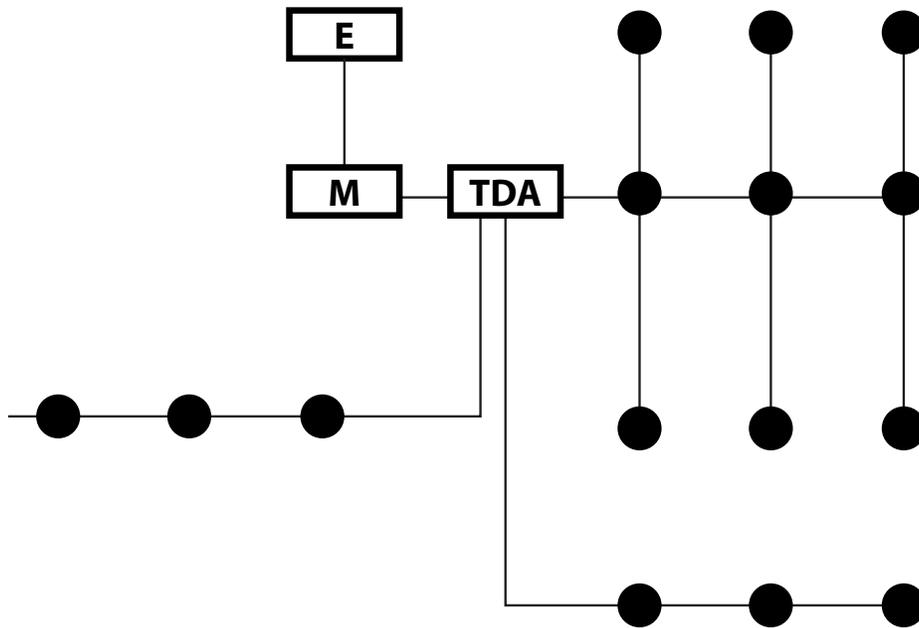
Figura XX. Esquema de canalización en PVC conduit (tubería plástica rígida)
